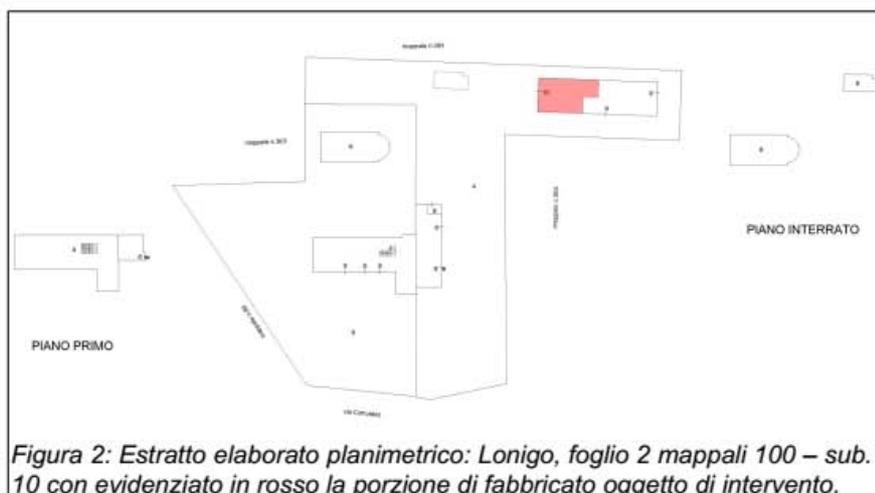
Estratto elaborato planimetrico: Lonigo, foglio 2 mappali 100 – sub. 10 con evidenziato in rosso la porzione di fabbricato oggetto di intervento.
